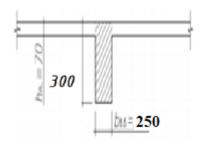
Расчетное сечение второстепенной балки при расчете на отрицательный изгибающий момент.
